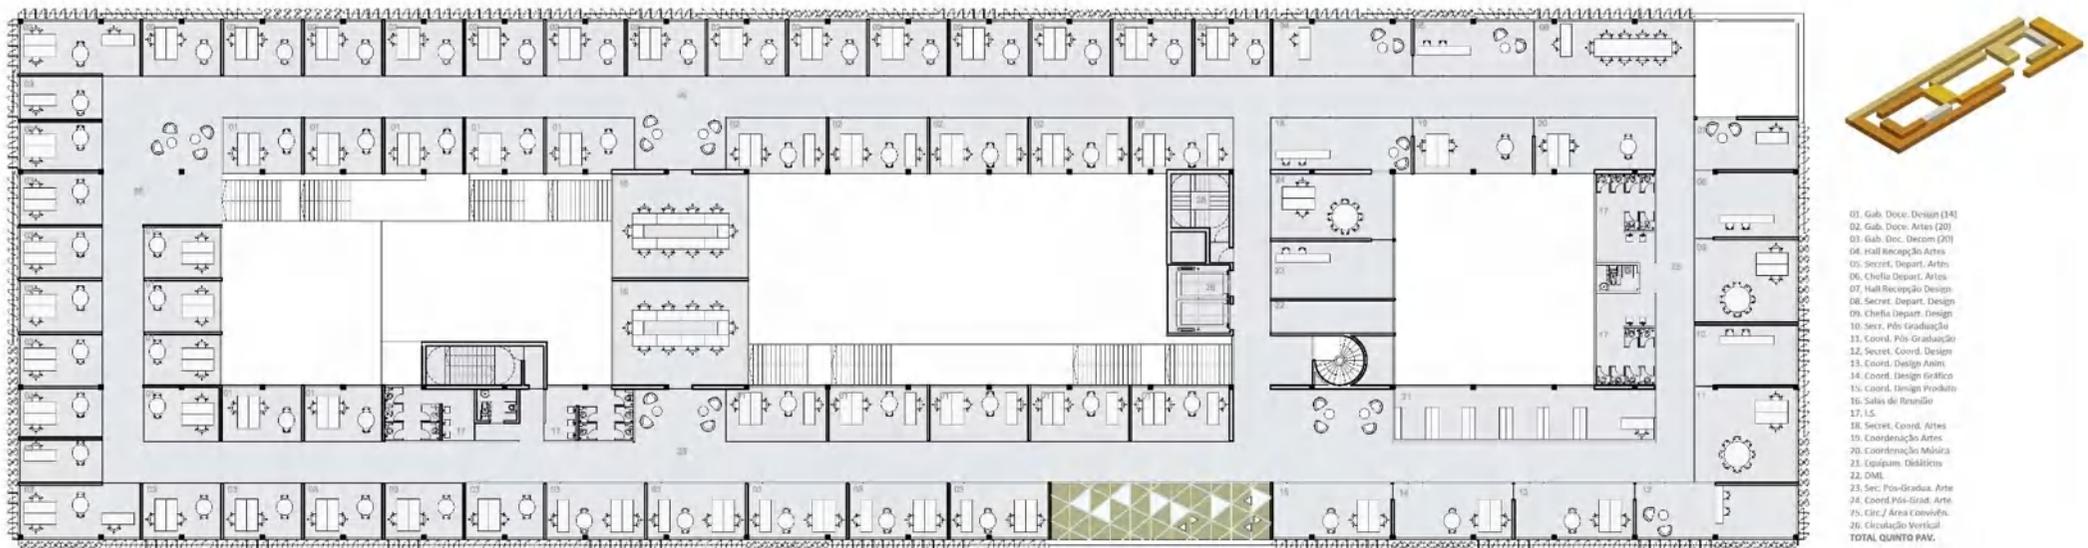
Planta baixa quarto pavimento do novo bloco Campus Cabral – UFPR (sem escala)
